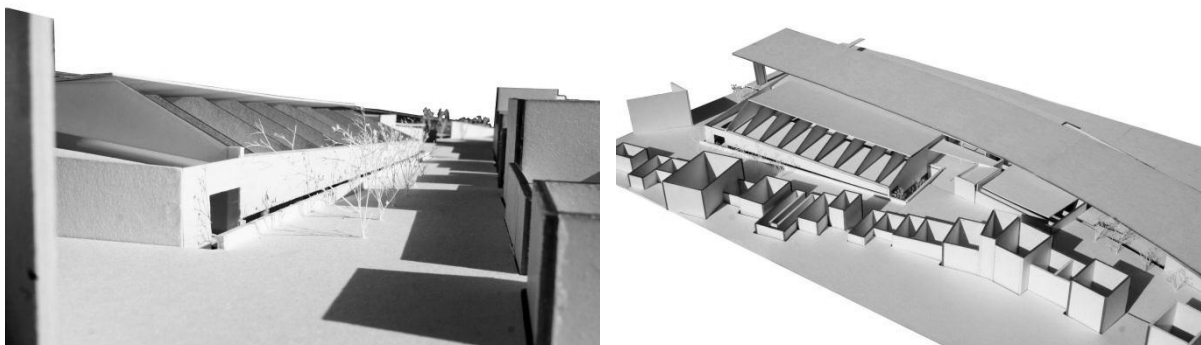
Fotografias da Maqueta – vistas exteriores.
